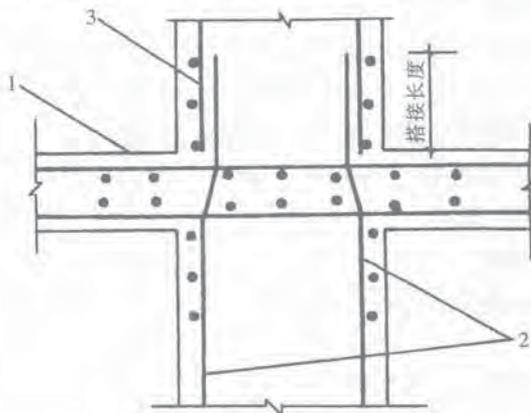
钢筋焊接网的竖向搭接图
